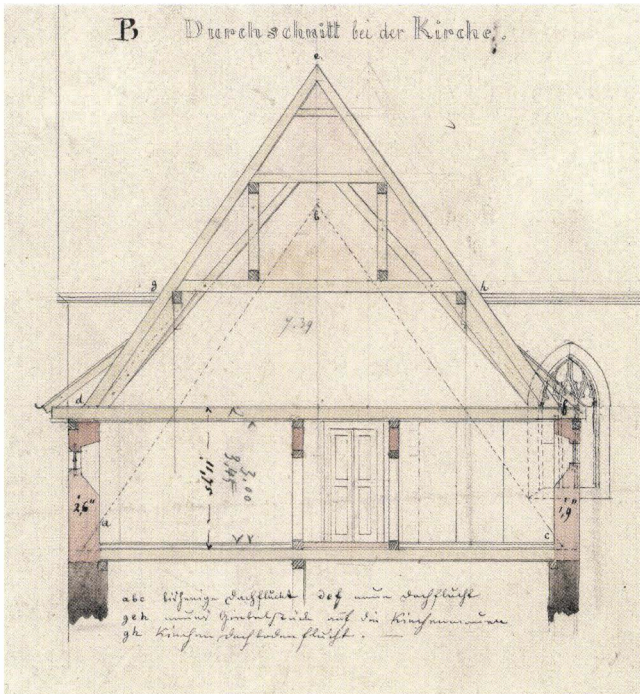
Lohnhof. Der Bauplan zeigt die projektierte Aufstockung des Armariums, Blick zur Leonhardskirche. Das alte Dachprofil ist eingestrichelt. Auf dem neuen Geschoss sitzt der alte Dachstuhl von 1440 in Wiederverwendung. Der Plan ist zwar undatiert und nicht signiert, doch kann er aufgrund der Darstellung sowie im Zusammenhang mit Schriftquellen als Bauplan von Amadeus Merian zur ausgeführten Aufstockung von 1853 identifiziert werden. – Plan StABS.
